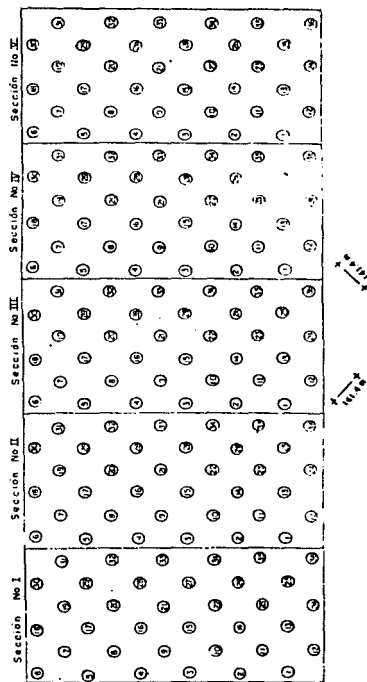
PLANTA DE LA INSTALACION DE POZOS EN EL LAGO
